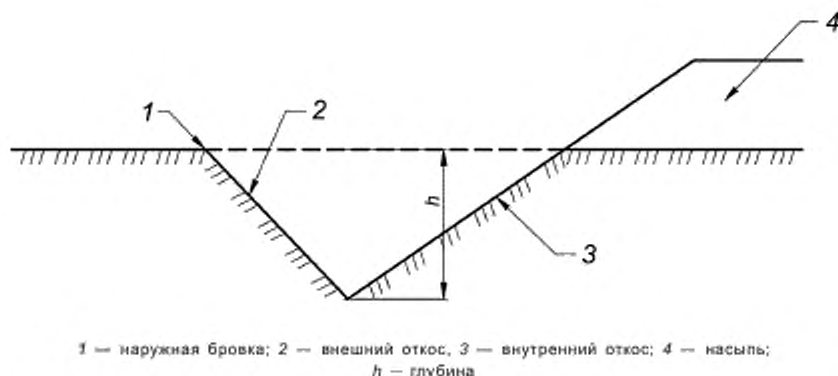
Конструкция боковой продольной канавы с сечением треугольной формы
